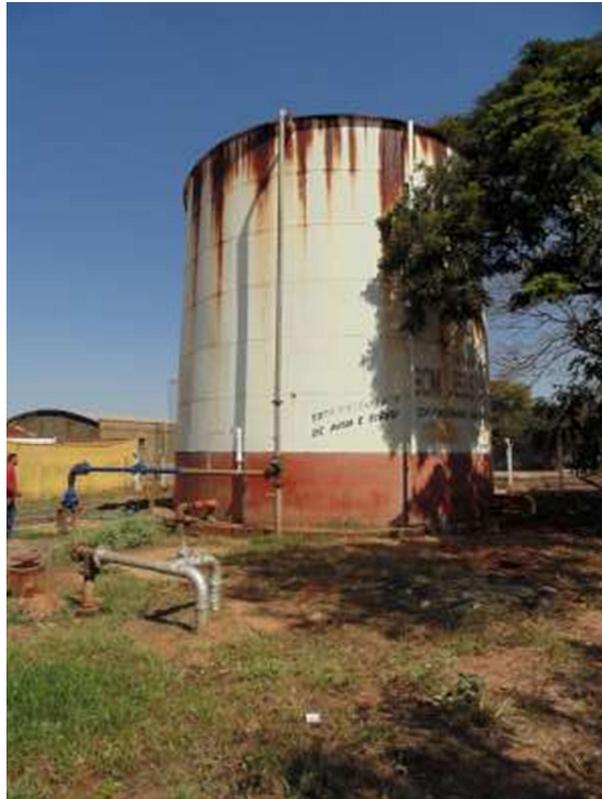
Vista geral do Poço P10 e reservatório R6. Em primeiro plano, antigo poço desativado.
